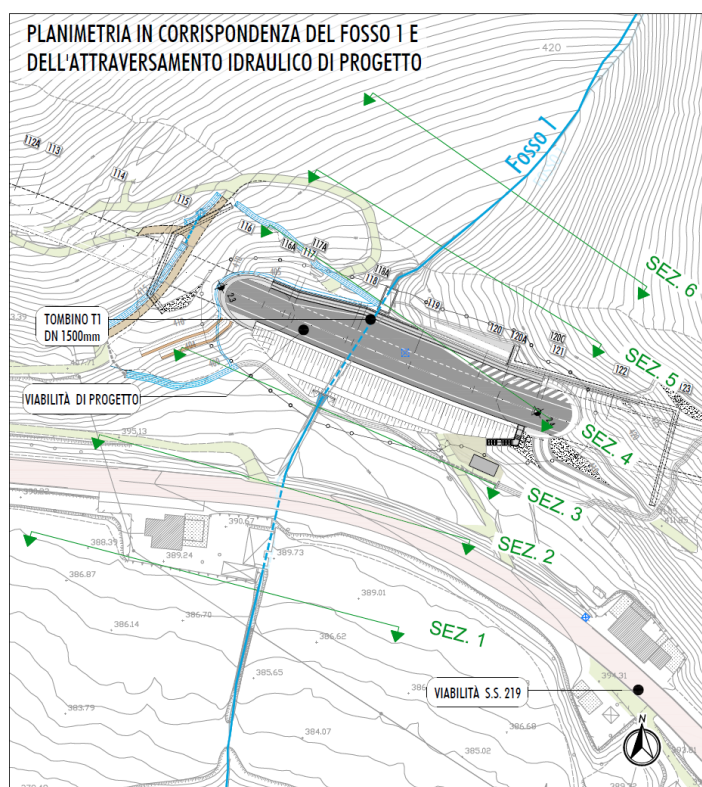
PLANIMETRIA DEL FOSSO 1
